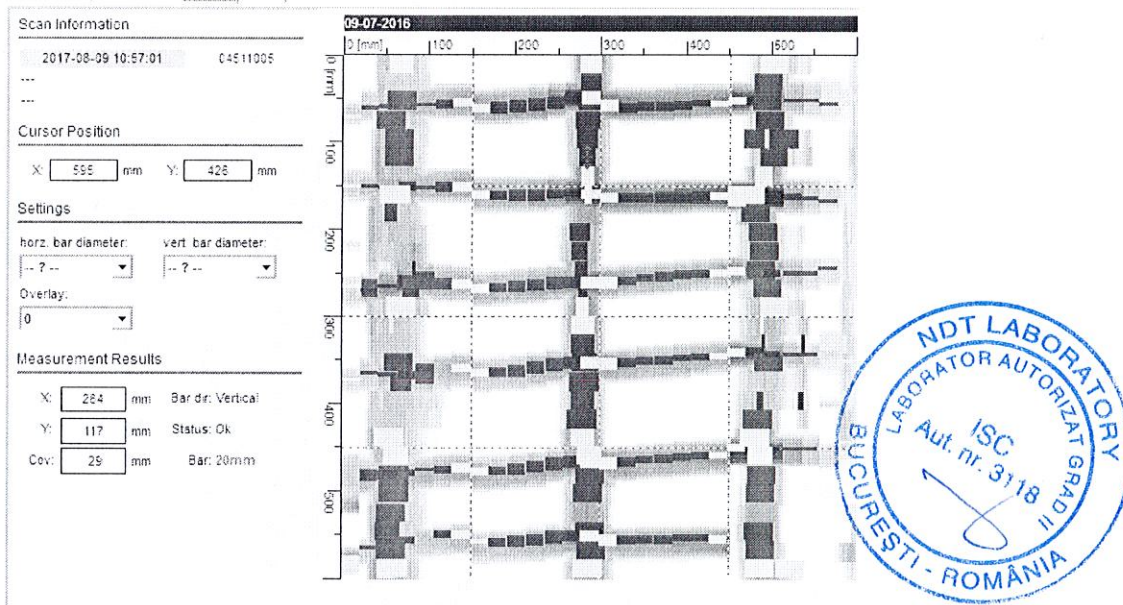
PAHOMETRIE PLANSEU PARTER-ARMARE 3 BARE 20 MM+ETR - 8MM/10C
